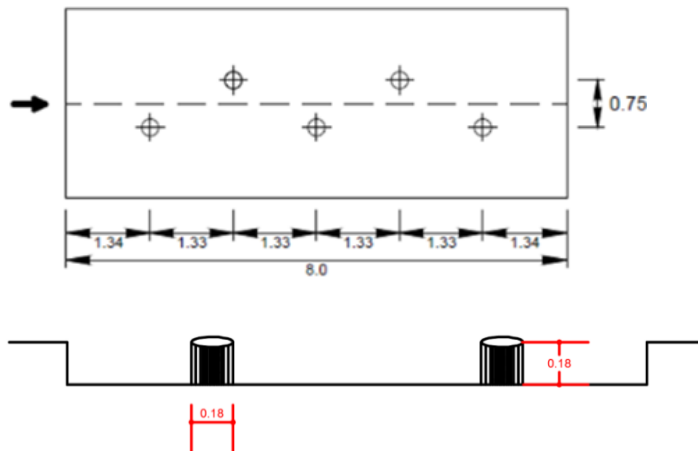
Vista en planta y detalle del obstáculo de vado.
